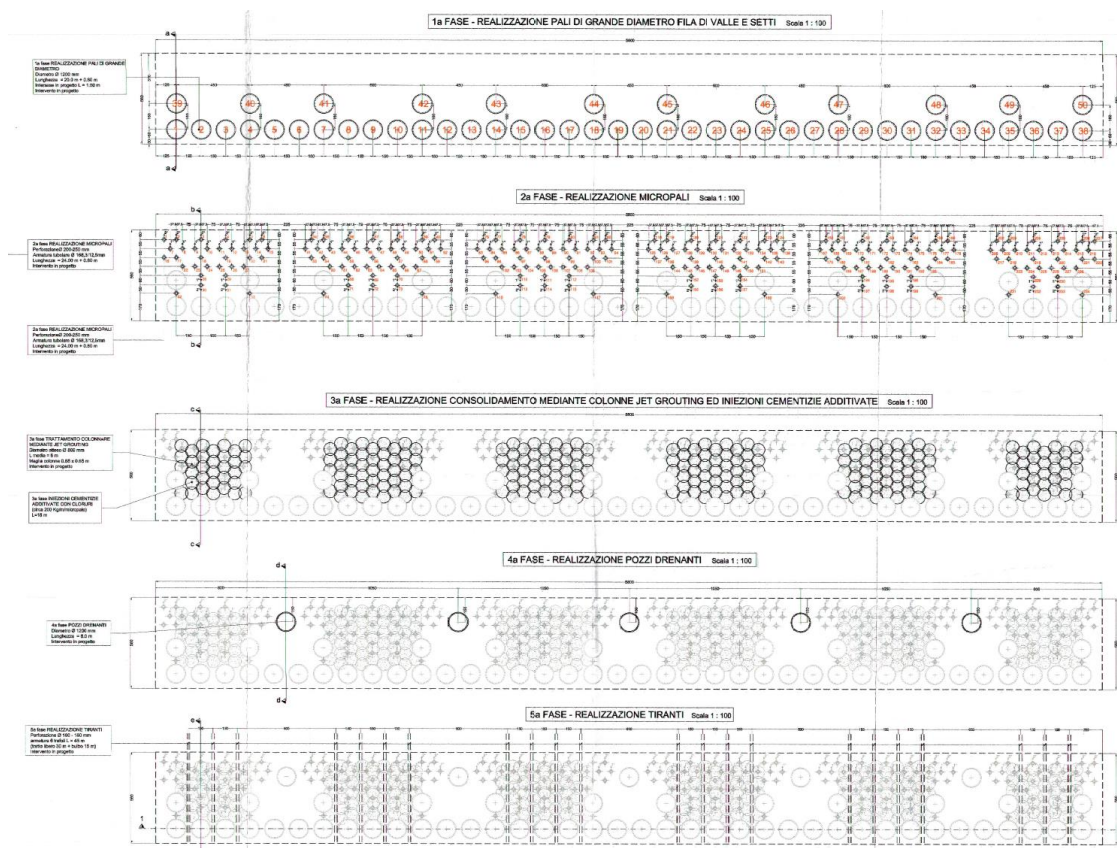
Stralcio degli interventi realizzati di consolidamento del muro crollato.
